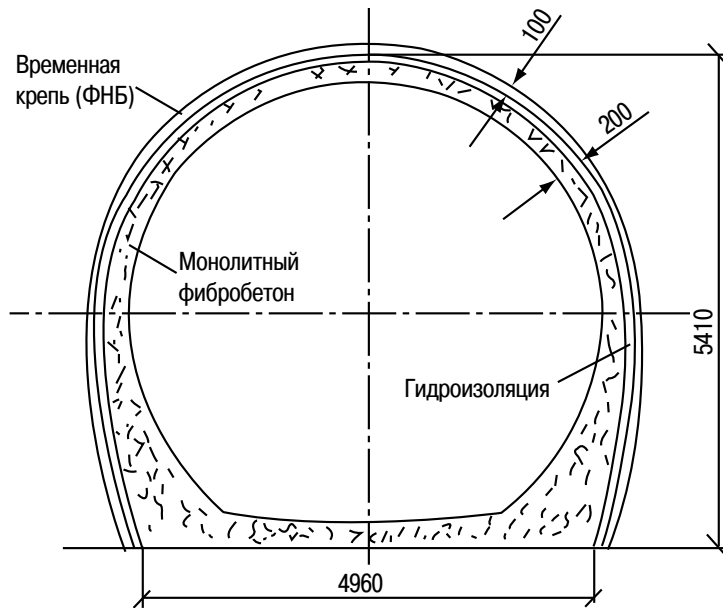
Эскиз проектного решения монолитной обделки тоннеля из фибробетона
